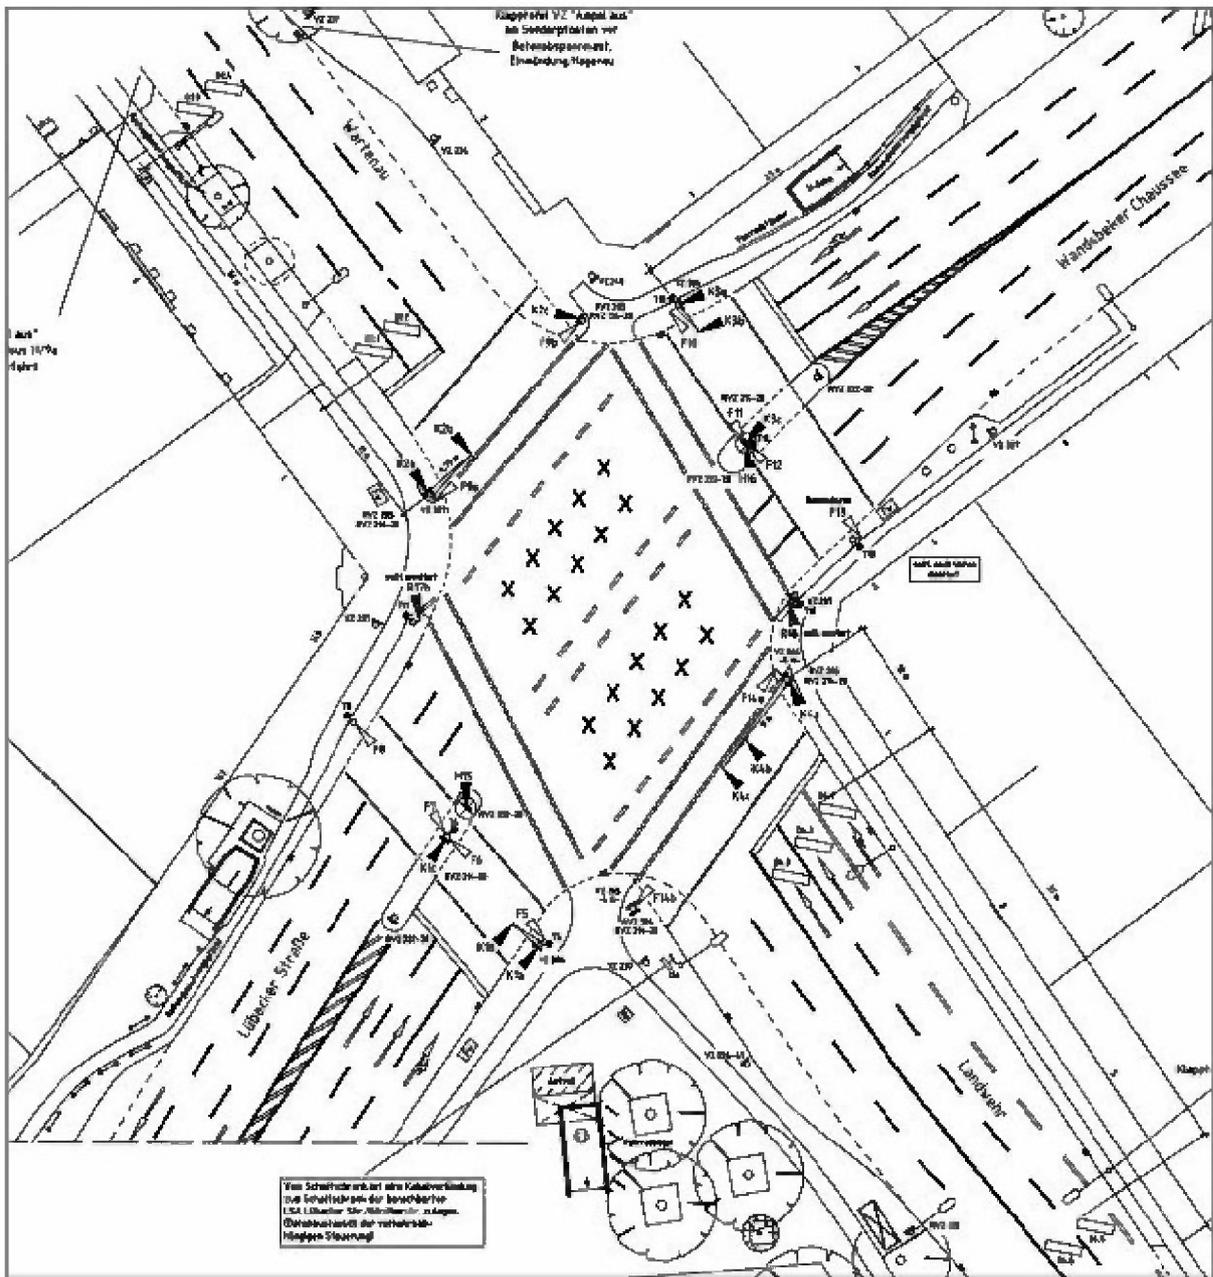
2 Signallageplanausschnitt LSA 129
